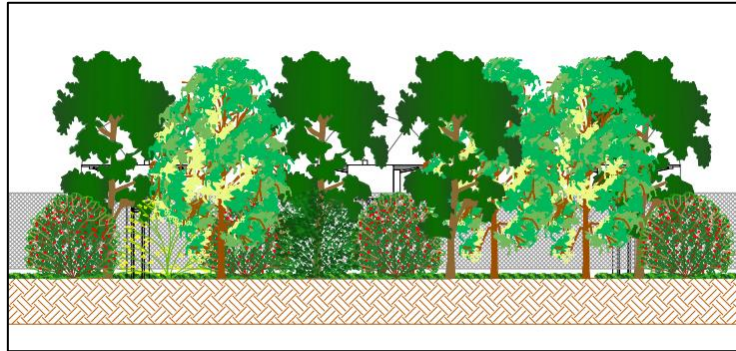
Prospetto esterno della recinzione perimetrale dell'impianto
